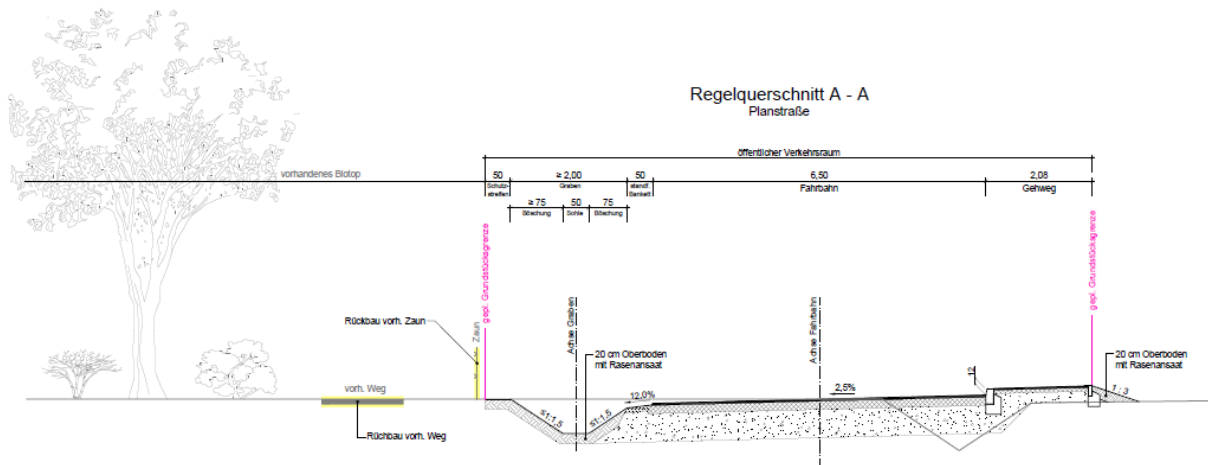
Planungsgesellschaft Scholz+Lewis mbH, Regelquerschnitt Planstraße
